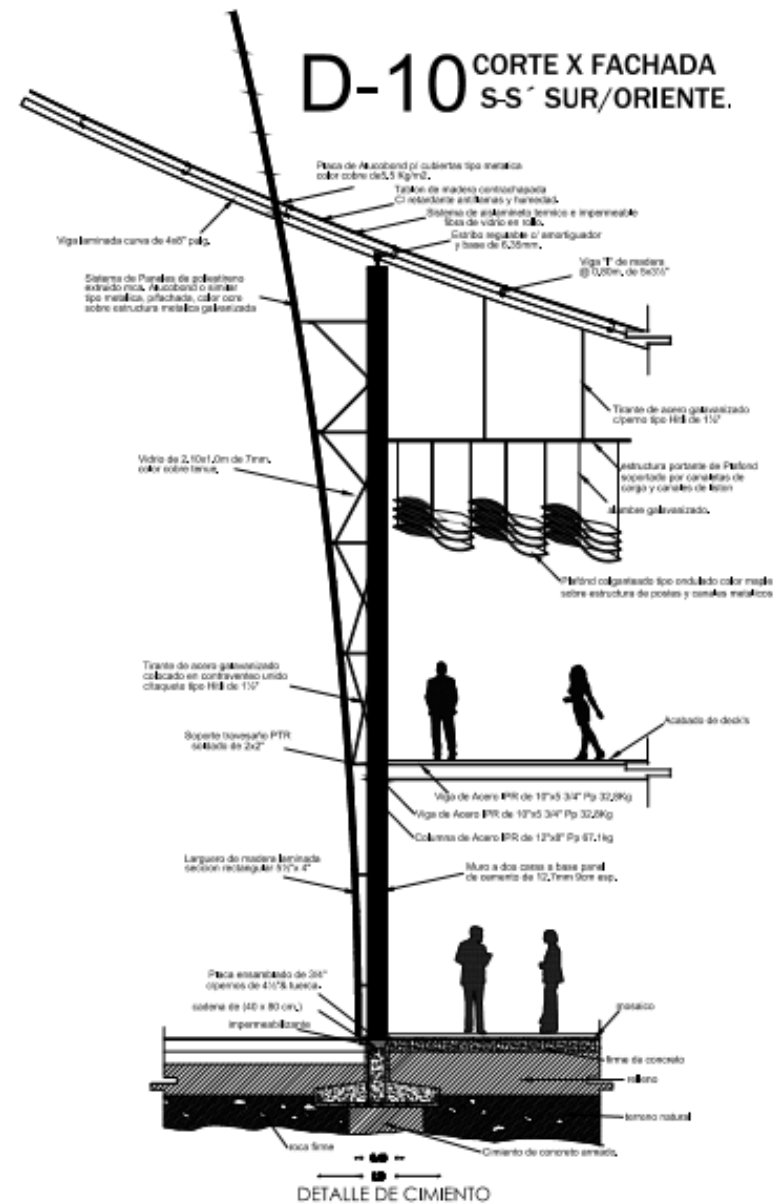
IMAGEN. Detalle Estructural para fachada de Nave de Cocción.
